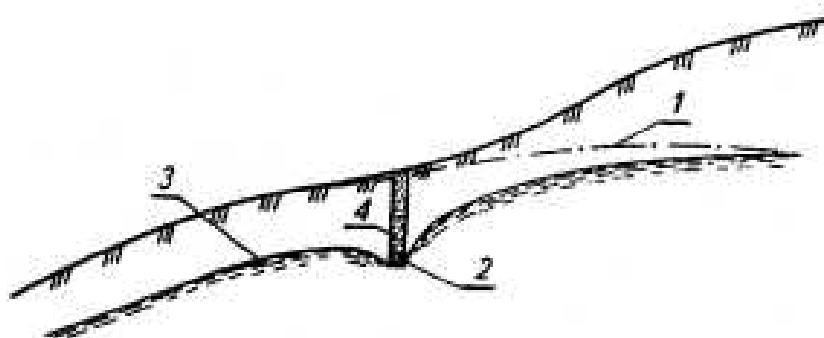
Схема понижения уровня грунтовой воды на оползневом участке закрытой дренажной системой: 1 - уровень грунтовых вод до строительства дренажа; 2 - дренаж; 3 - кривая депрессии; 4 - обратная засыпка траншеи с уплотнением
